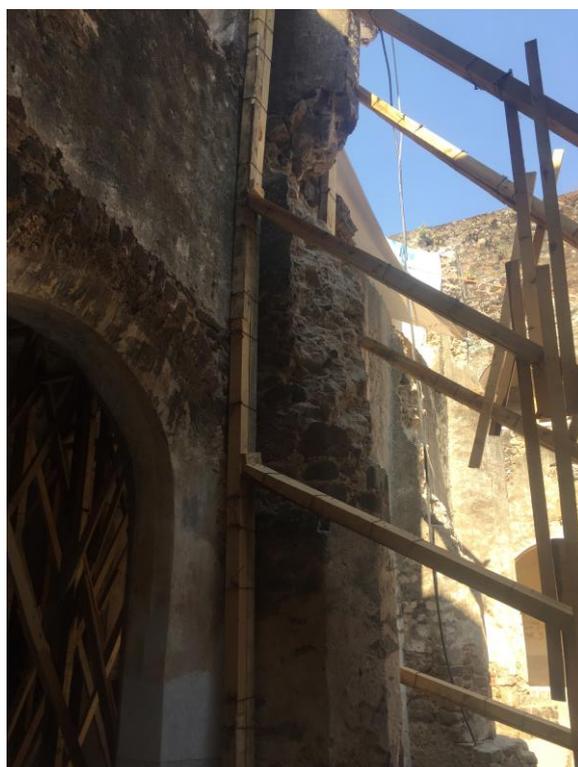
Apuntalamiento contrafuerte fachada oriente del claustro, 2018.
